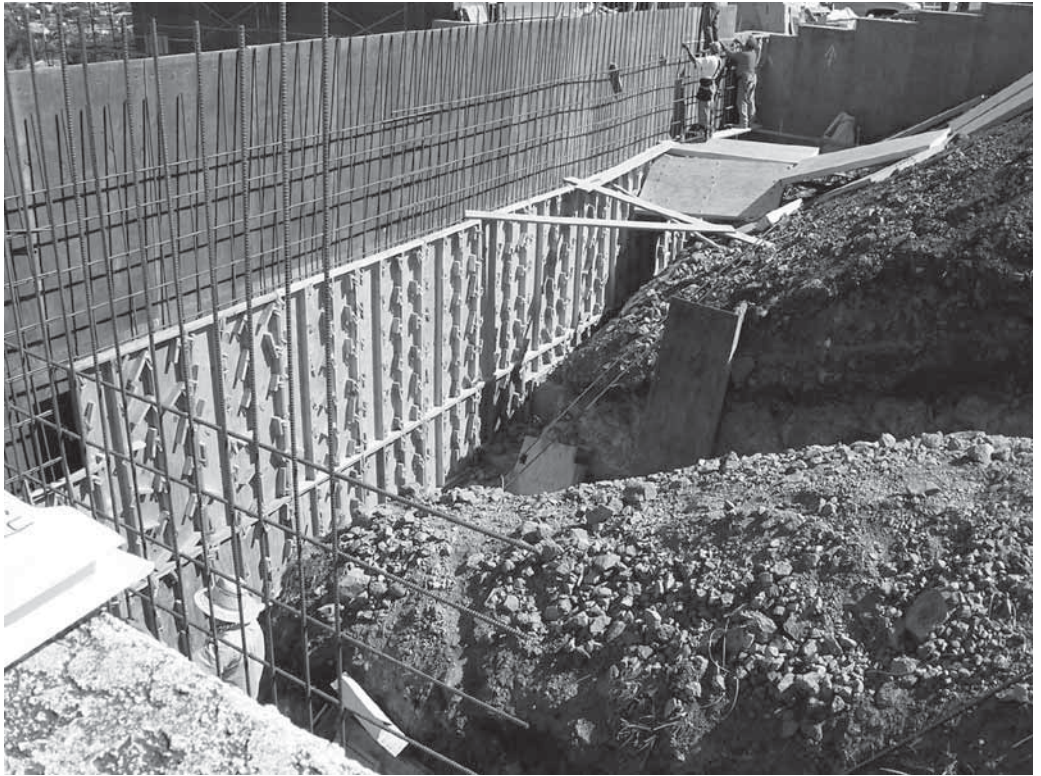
Muro de retención en voladizo en proceso de construcción. (Cortesía de Dharma Shakya, Geotechnical Solutions, Inc., Irvine, California.)
